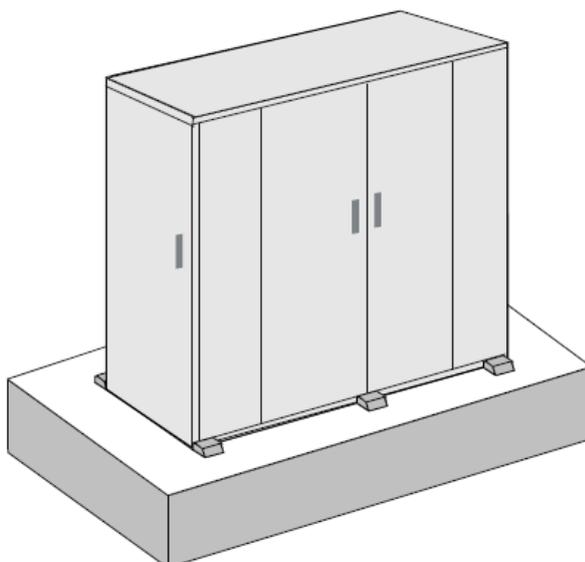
Gabinete Instalado sobre un pedestal de concreto”¹⁰
